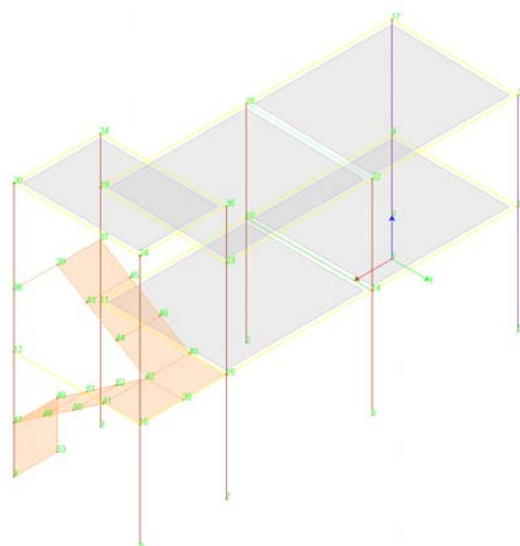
Modello agli elementi finiti – Struttura in elevazione – Unifilare
